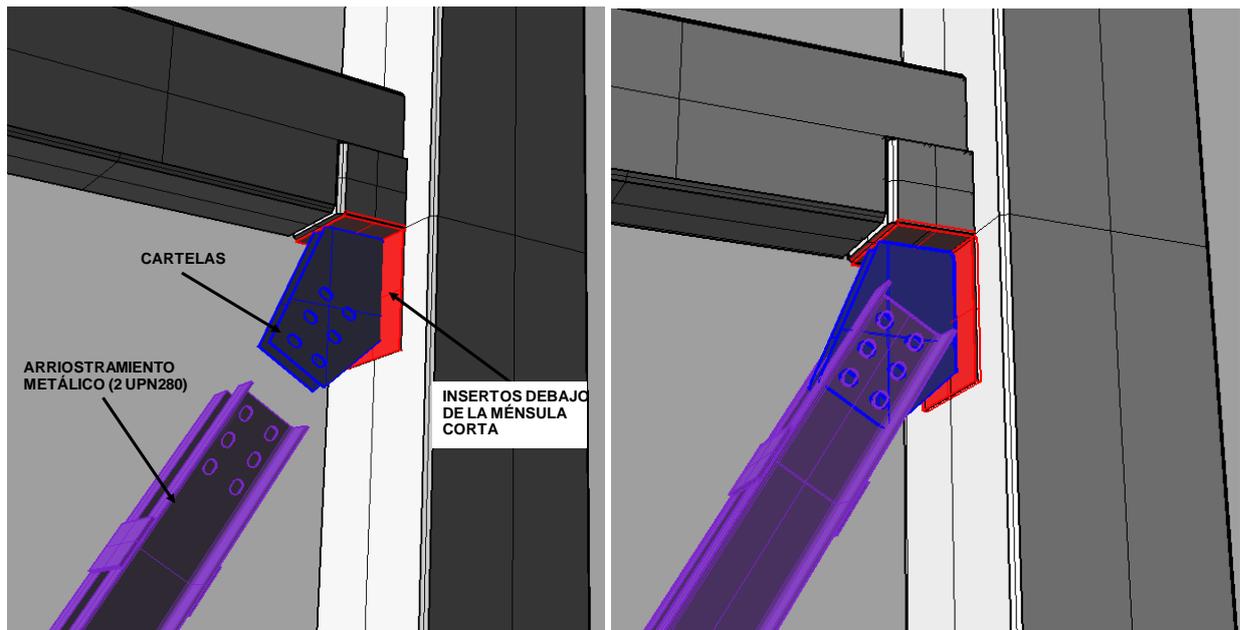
Esquema de conexión entre el arriostramiento y la columna
